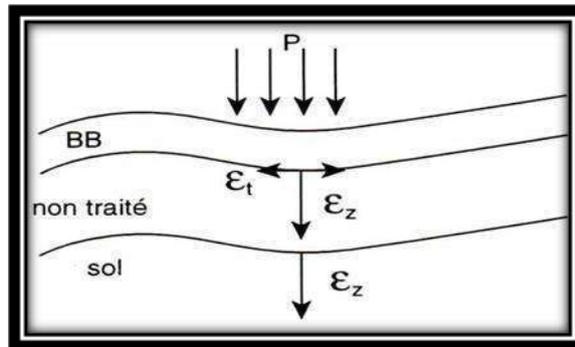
Schémas de fonctionnement d'une structure de chaussée
